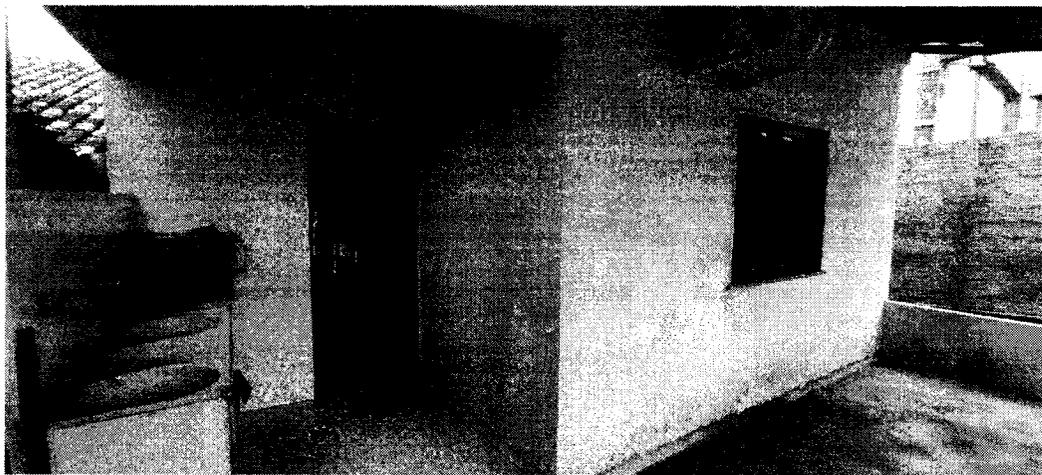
e 03: Hall de entrada , sala/cozinha.
